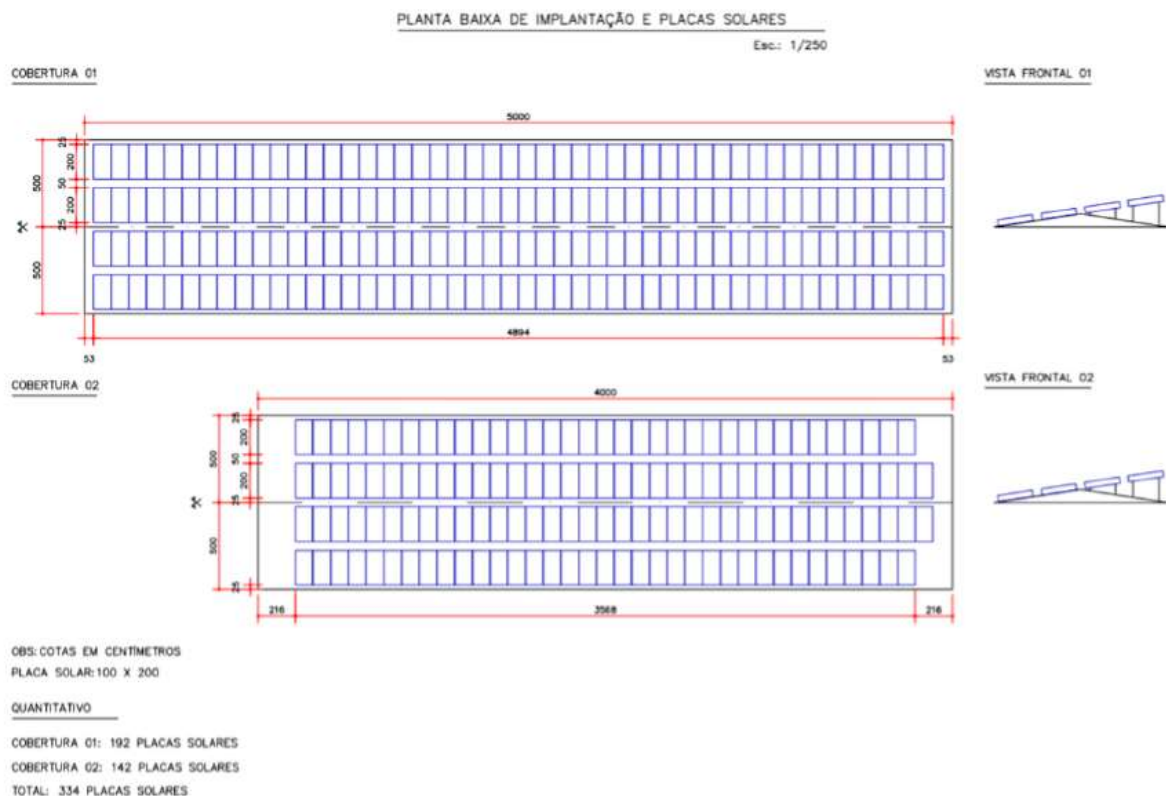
Planta baixa de implantação do arranjo fotovoltaico
